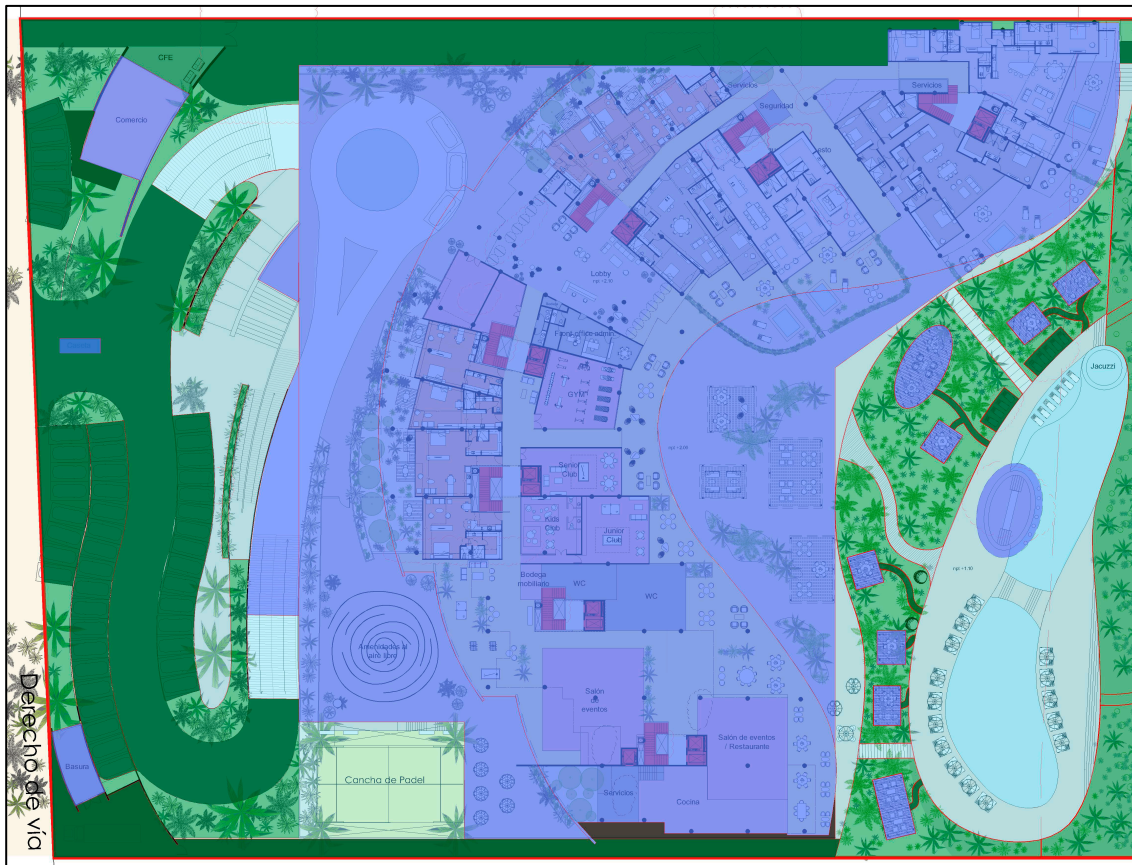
ÁREA NO PERMEABLE TECHADO EN PLANTA BAJA
